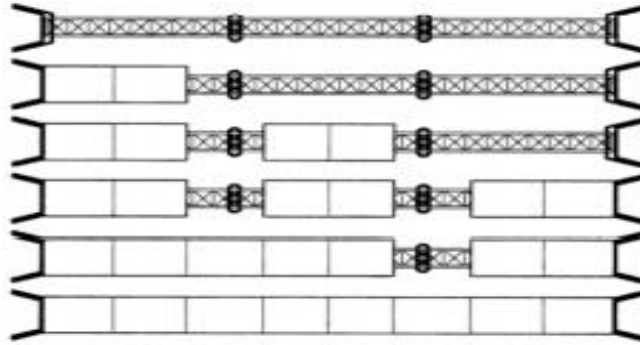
Betonagem sequencial da laje de betão numa ponte mista [30]
